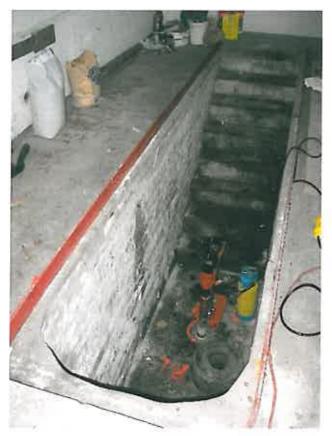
Arbeitsgrube im Garagenanbau (Ansatzpunkt der Bohrung BS 9)
